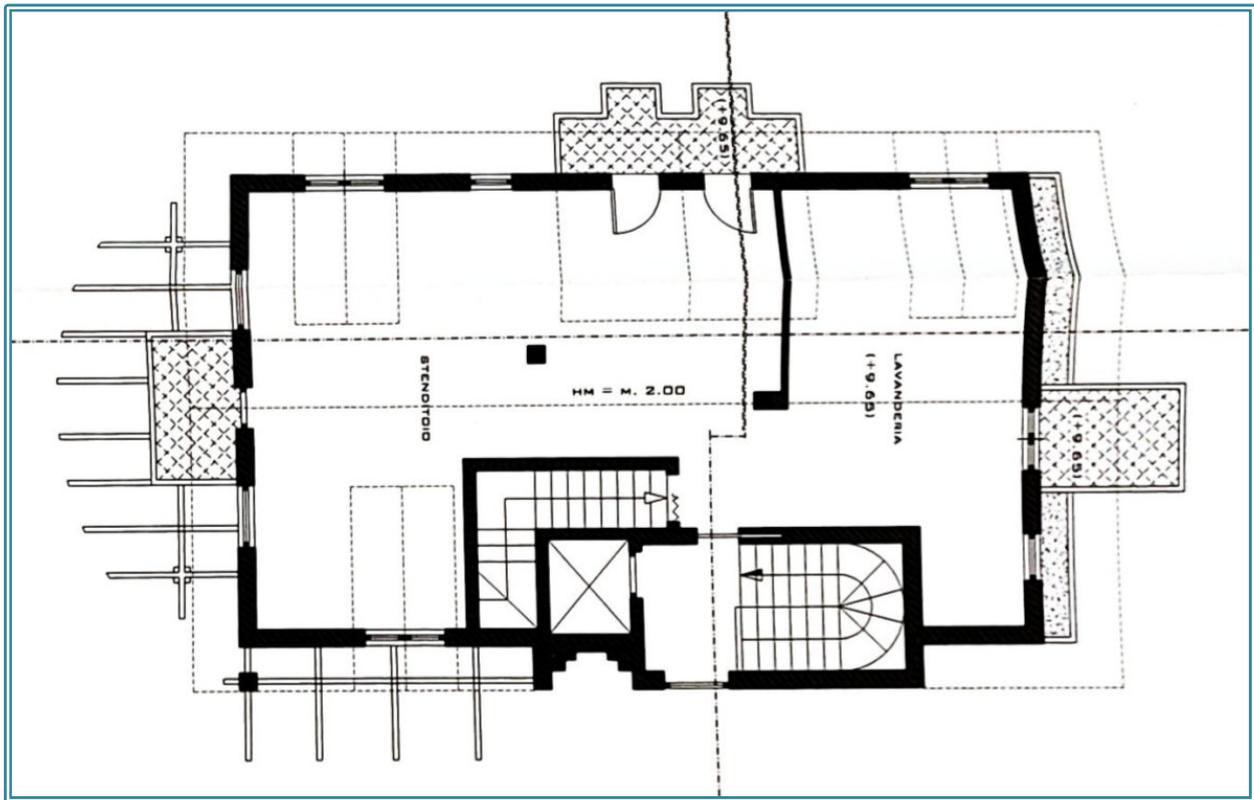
Pianta Piano Terzo (Sottotetto) – P.d.C. n. 57 (LOTTO 4)
